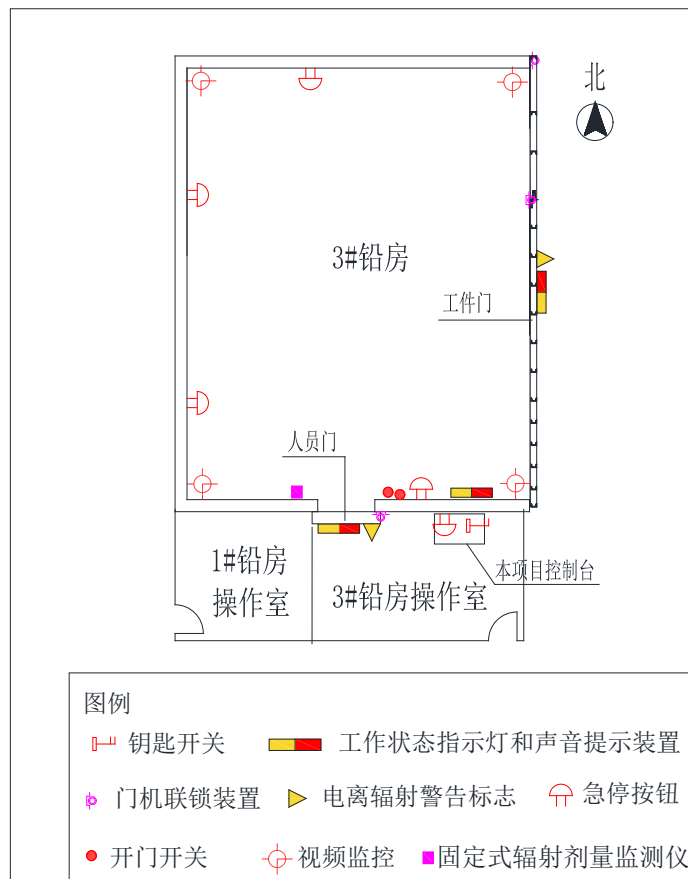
本项目设置的辐射安全和防护设施平面布置示意图
